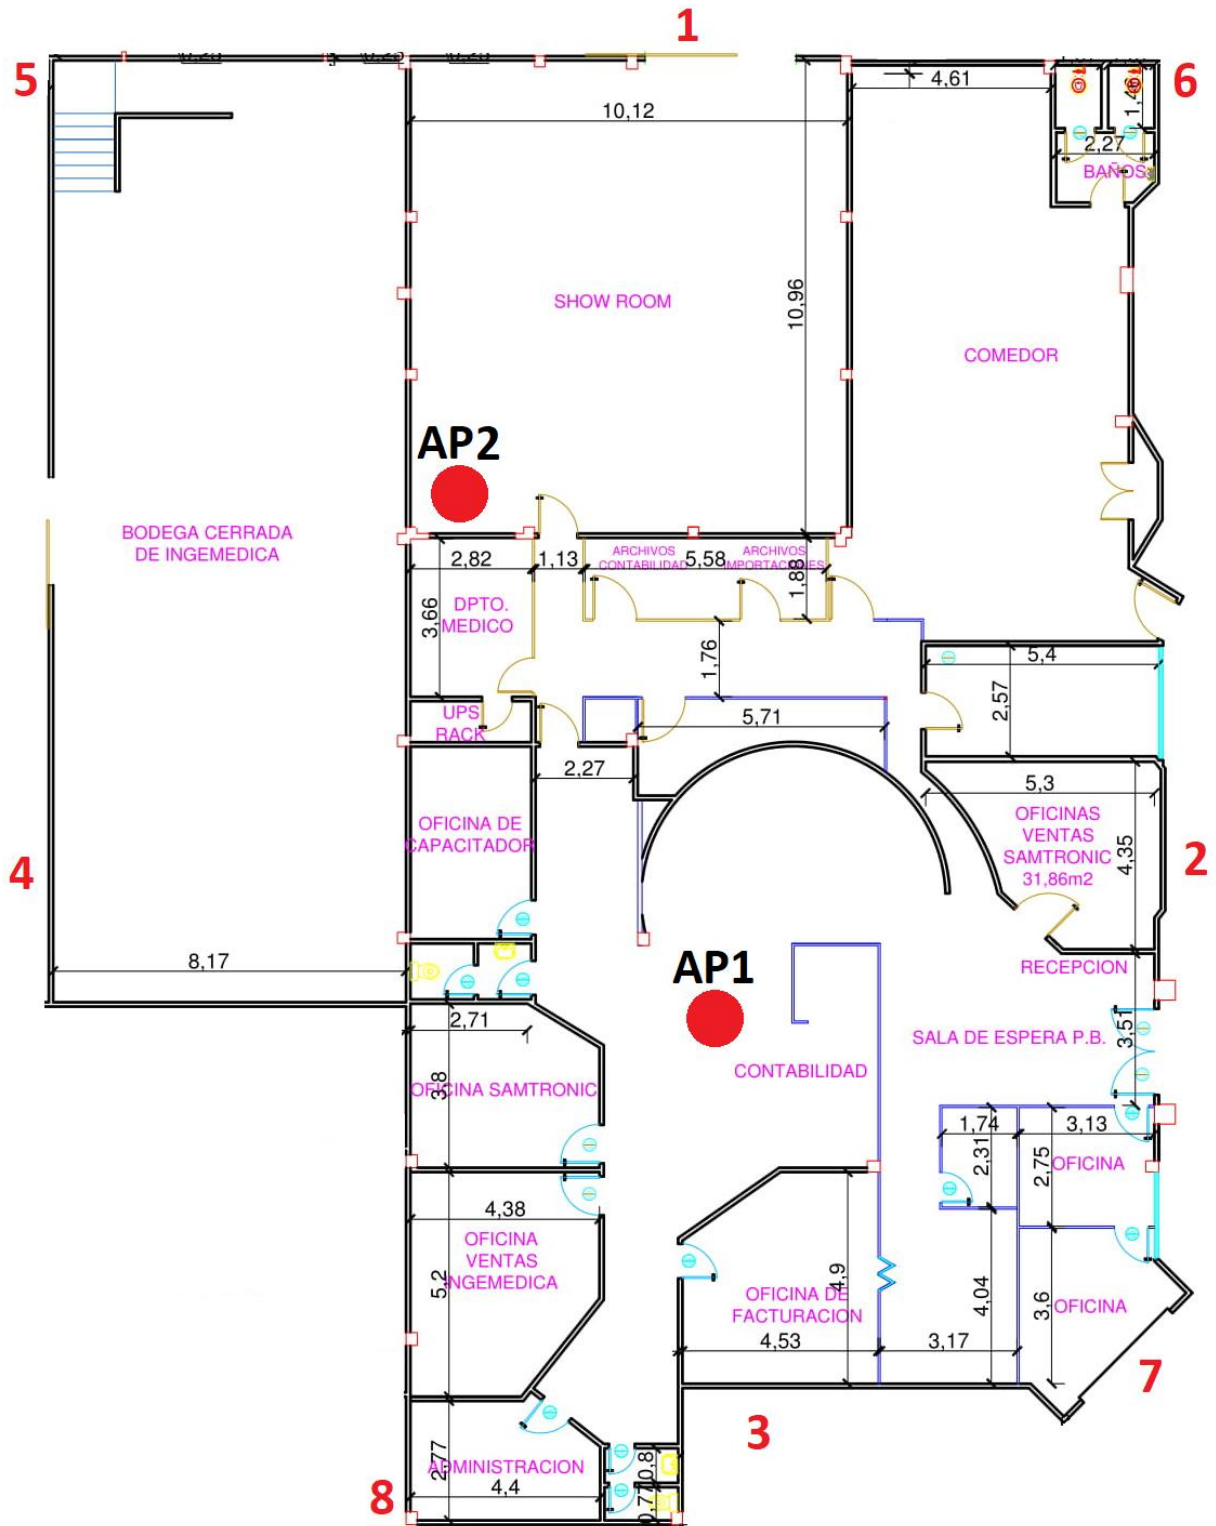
Ubicación de los AP en la planta baja, diseño final
